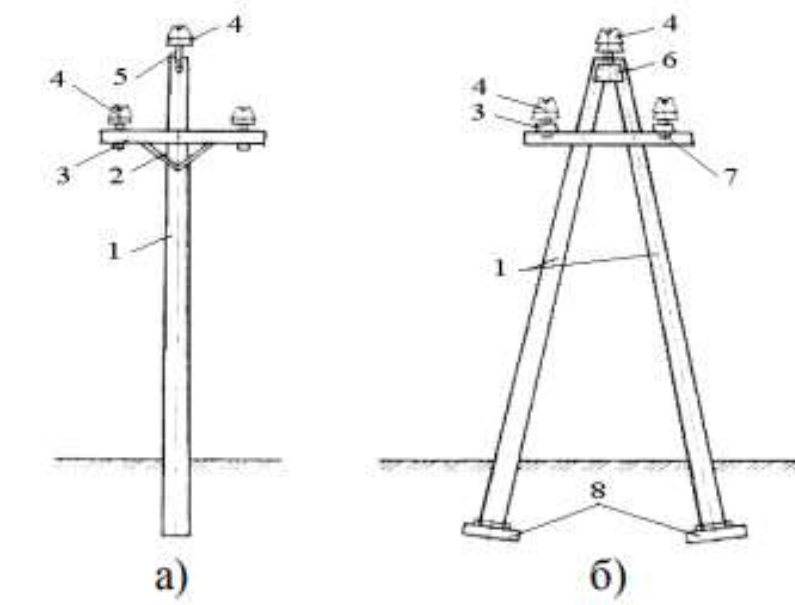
Залізобетонні опори ПЛ на напругу 6-10 кВ із центрофугованих стійок: а) проміжна; б) анкерна; 1 - стійка; 2 - розкоси; 3 - траверси; 4 - ізолятори; 5 - верхівковий штир; 6 - металева пластина; 7- підтраверсники; 8 - анкерно-опорні плити.
